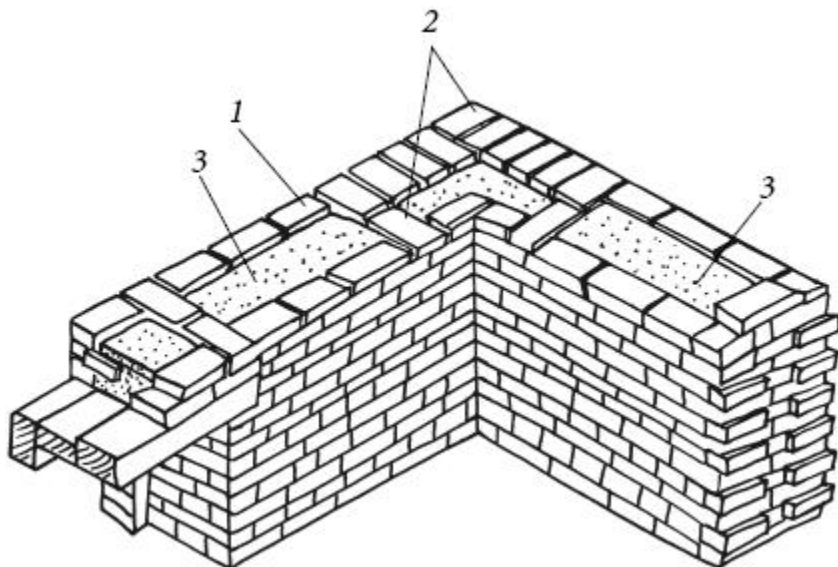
Облегченная колодцевая кладка стены: 1) продольные стенки; 2) поперечные стенки; 3) внутренний слой утеплителя
